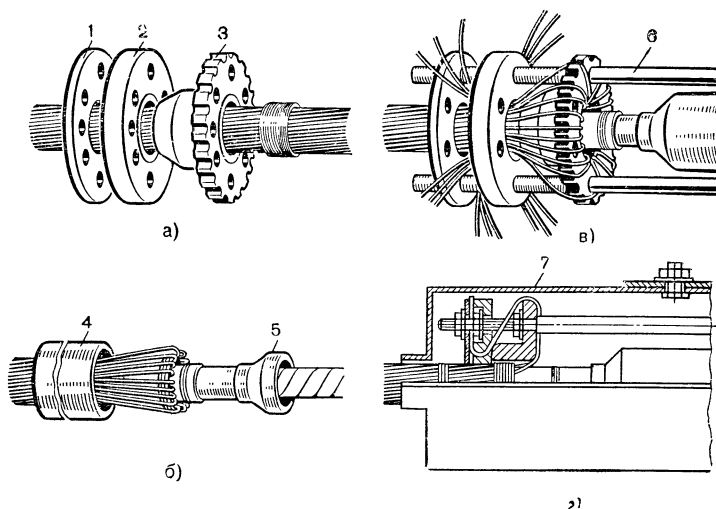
Монтаж стяжной защитной муфты: а) установка деталей для монтажа; б) разделка конца кабеля; в) заделка проволок брони; г) общий вид (в разрезе)
